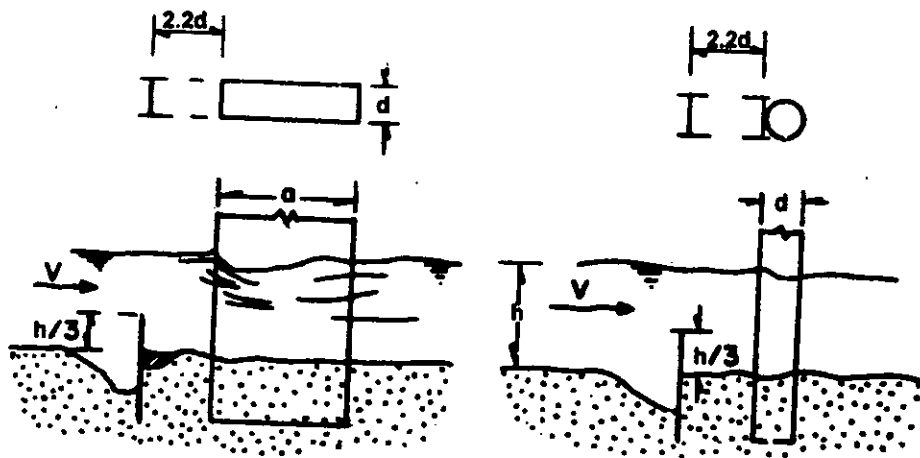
Colocación de pantallas planas para la protección de pilas, de acuerdo con Levi-Luna (1960)⁽⁷¹⁾.
